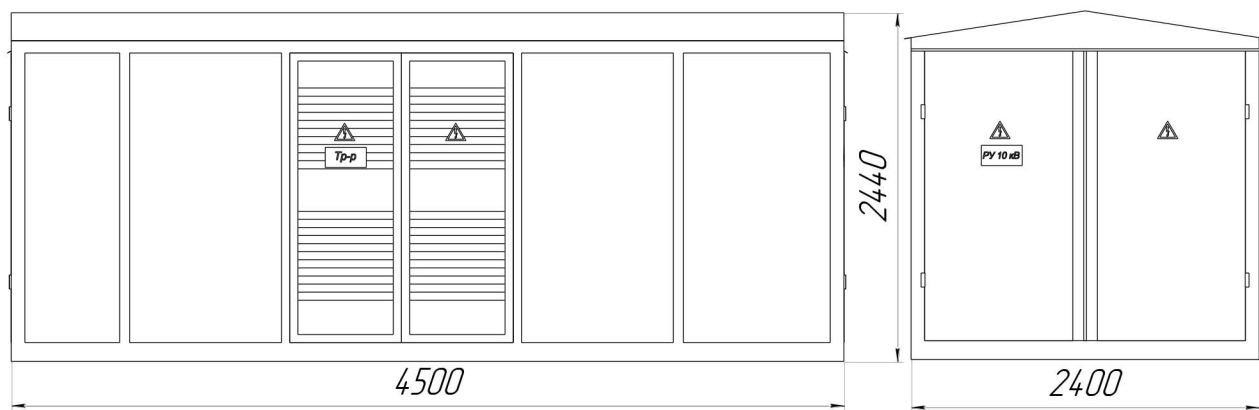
Габаритные размеры КТПГС с коридорами обслуживания
